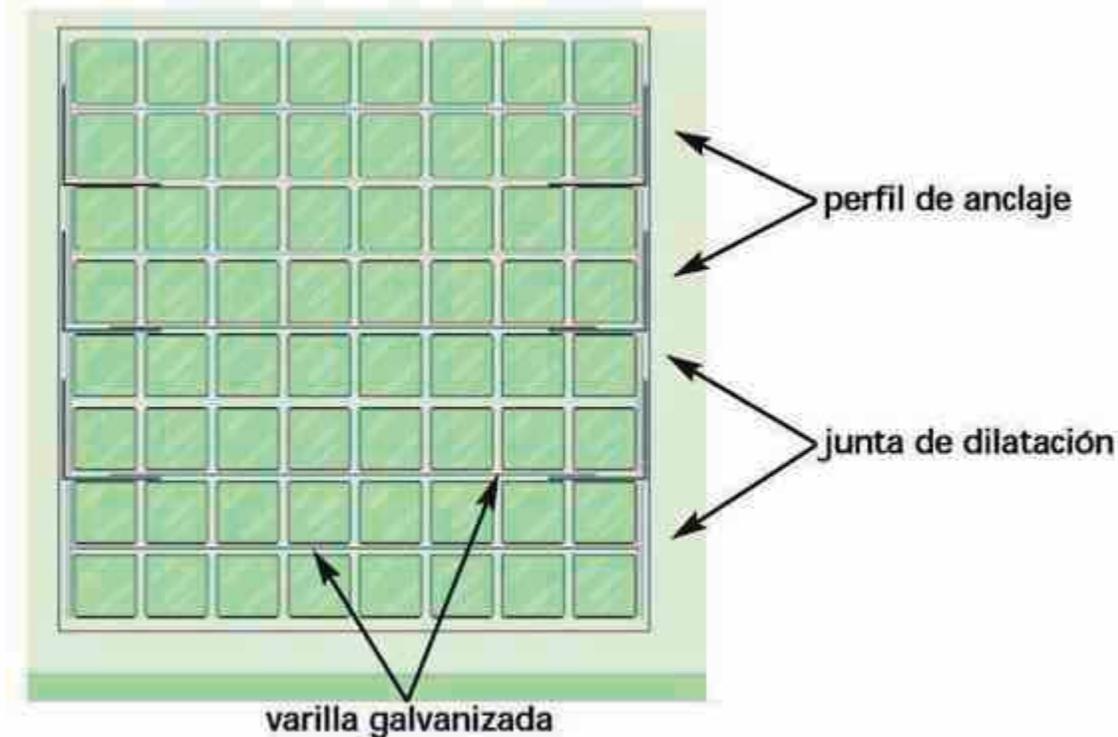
Muro de bloques de vidrio, fuente: www.leroymerlin.es
